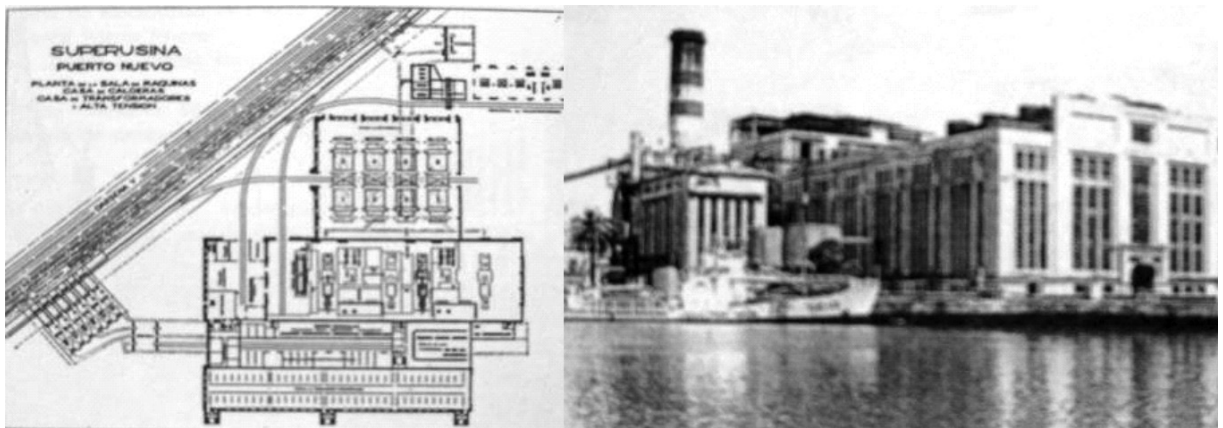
Usina de Electricidad CHADE. Planta y vista.
